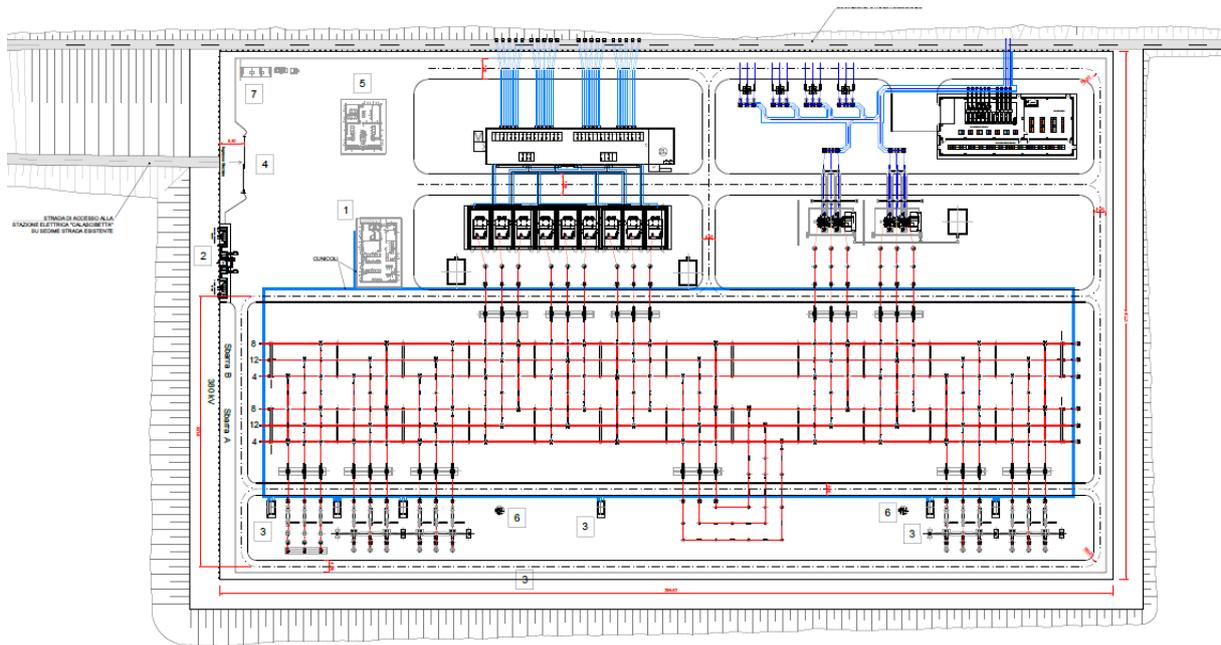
Planimetria elettromeccanica SE “Calascibetta”
